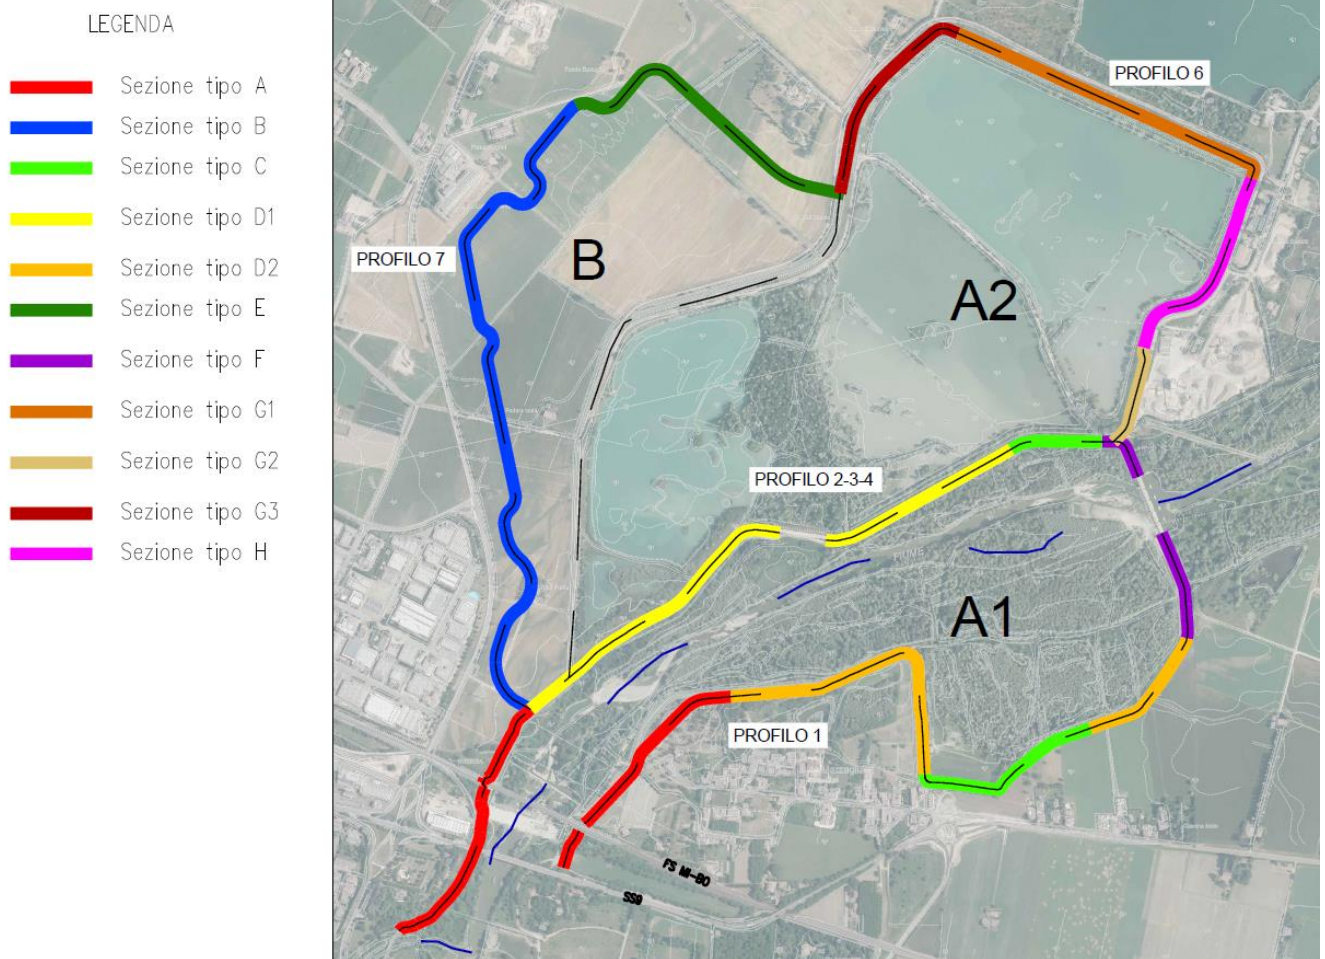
Ubicazione in pianta delle sezioni di verifica
